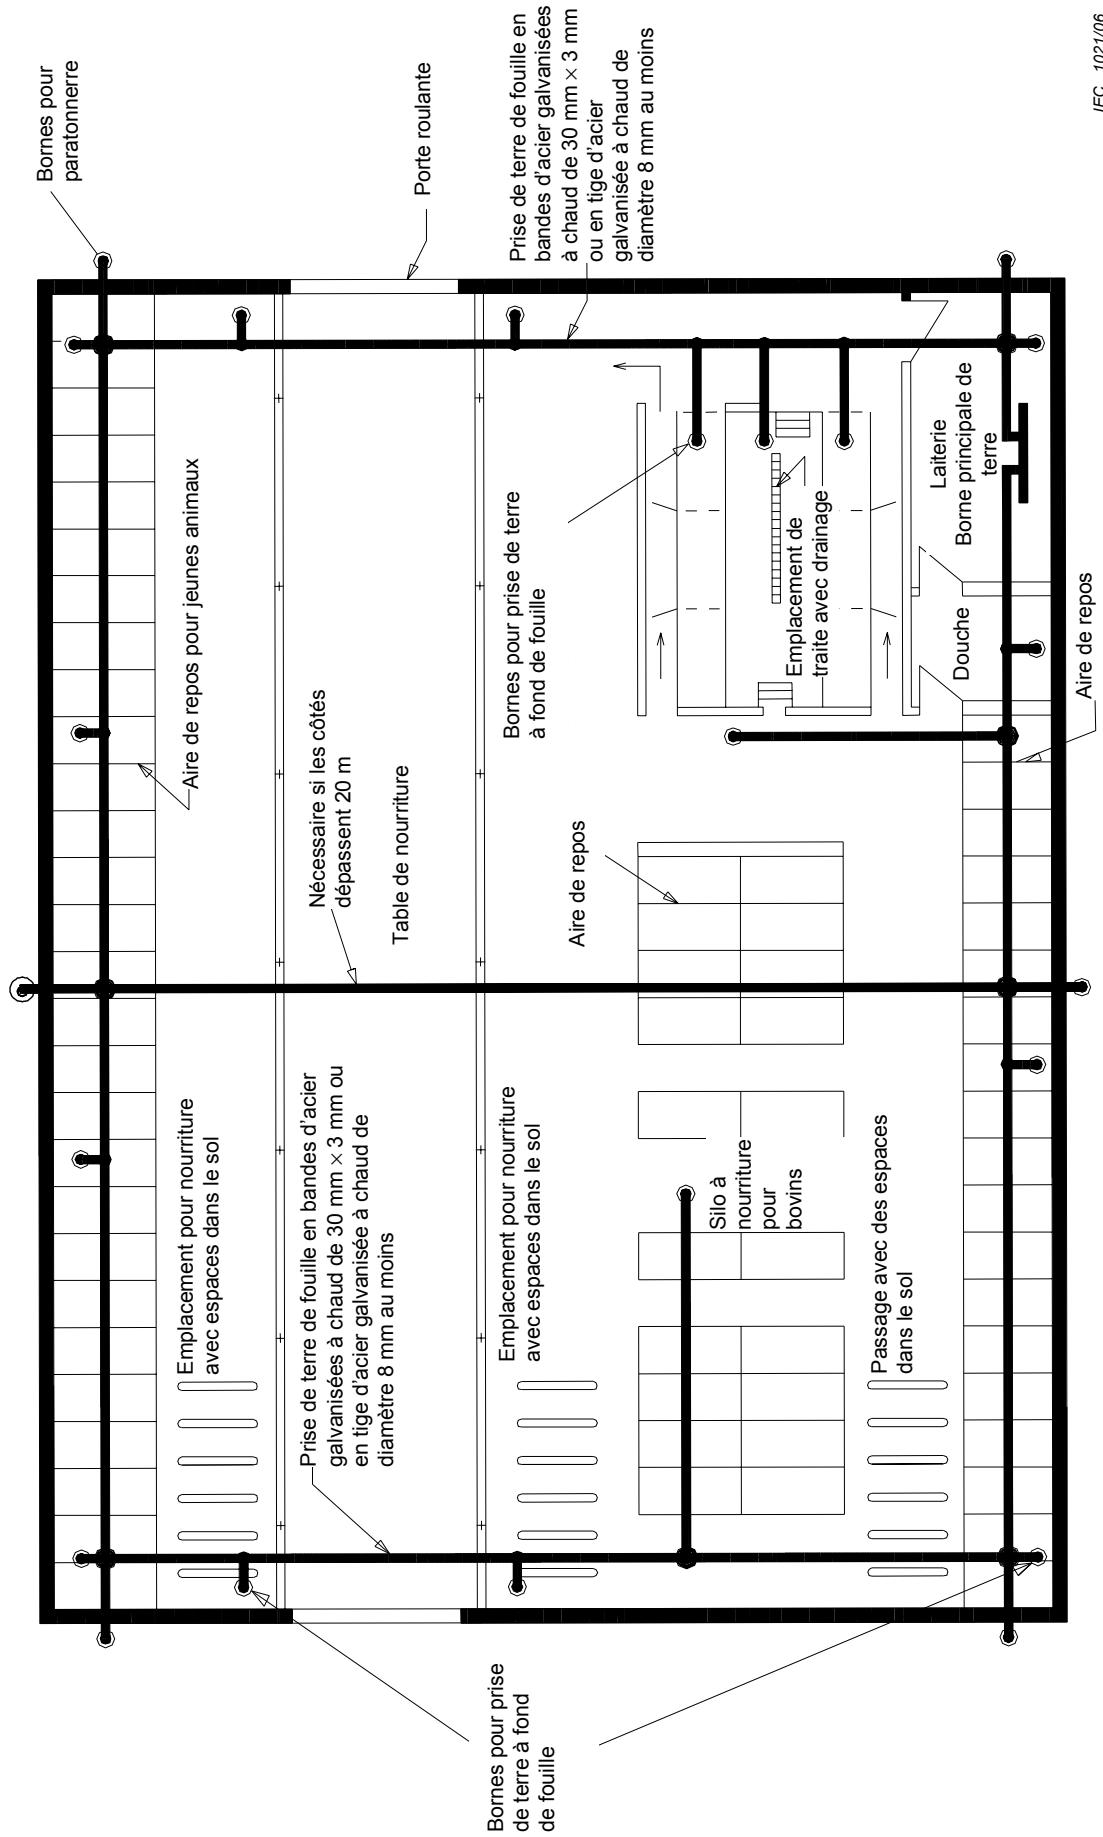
Exemple de disposition d'une prise de terre à fond de fouille dans une étable
